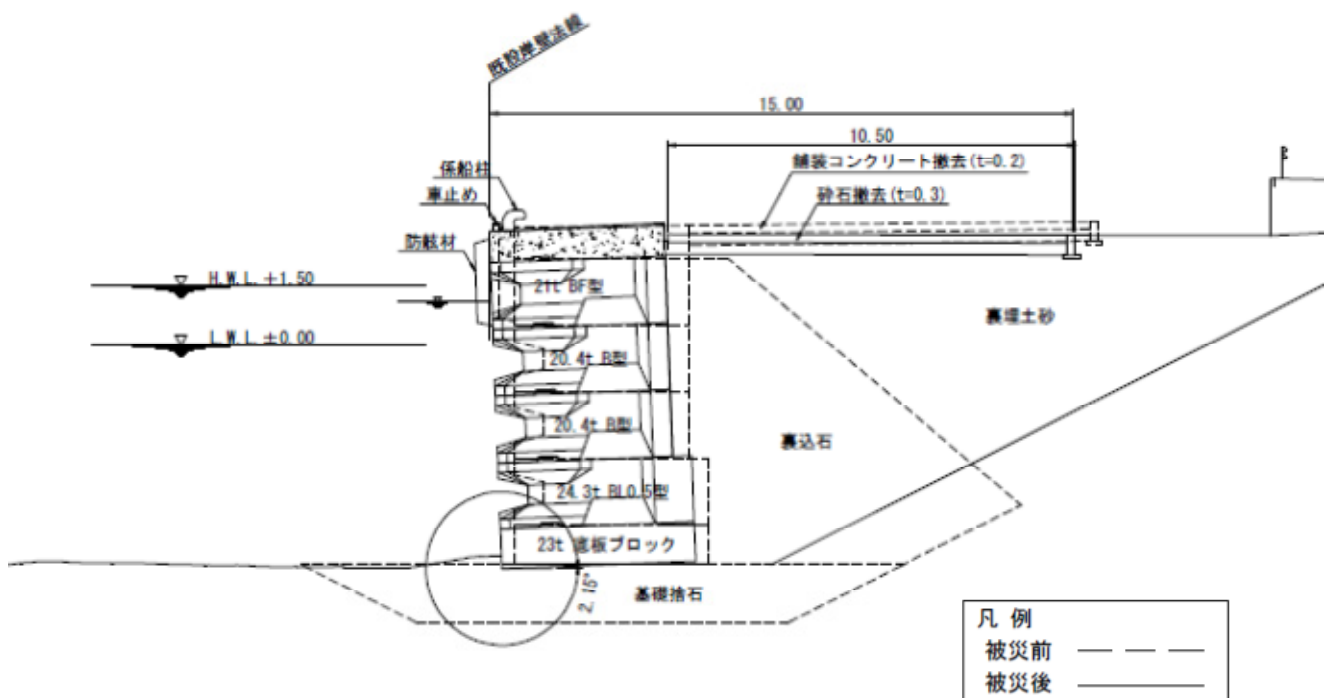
248 No.22 常陸那珂港区\_南埠頭地区 B 岸壁 (-5.5m) の断面図 (被災後)
